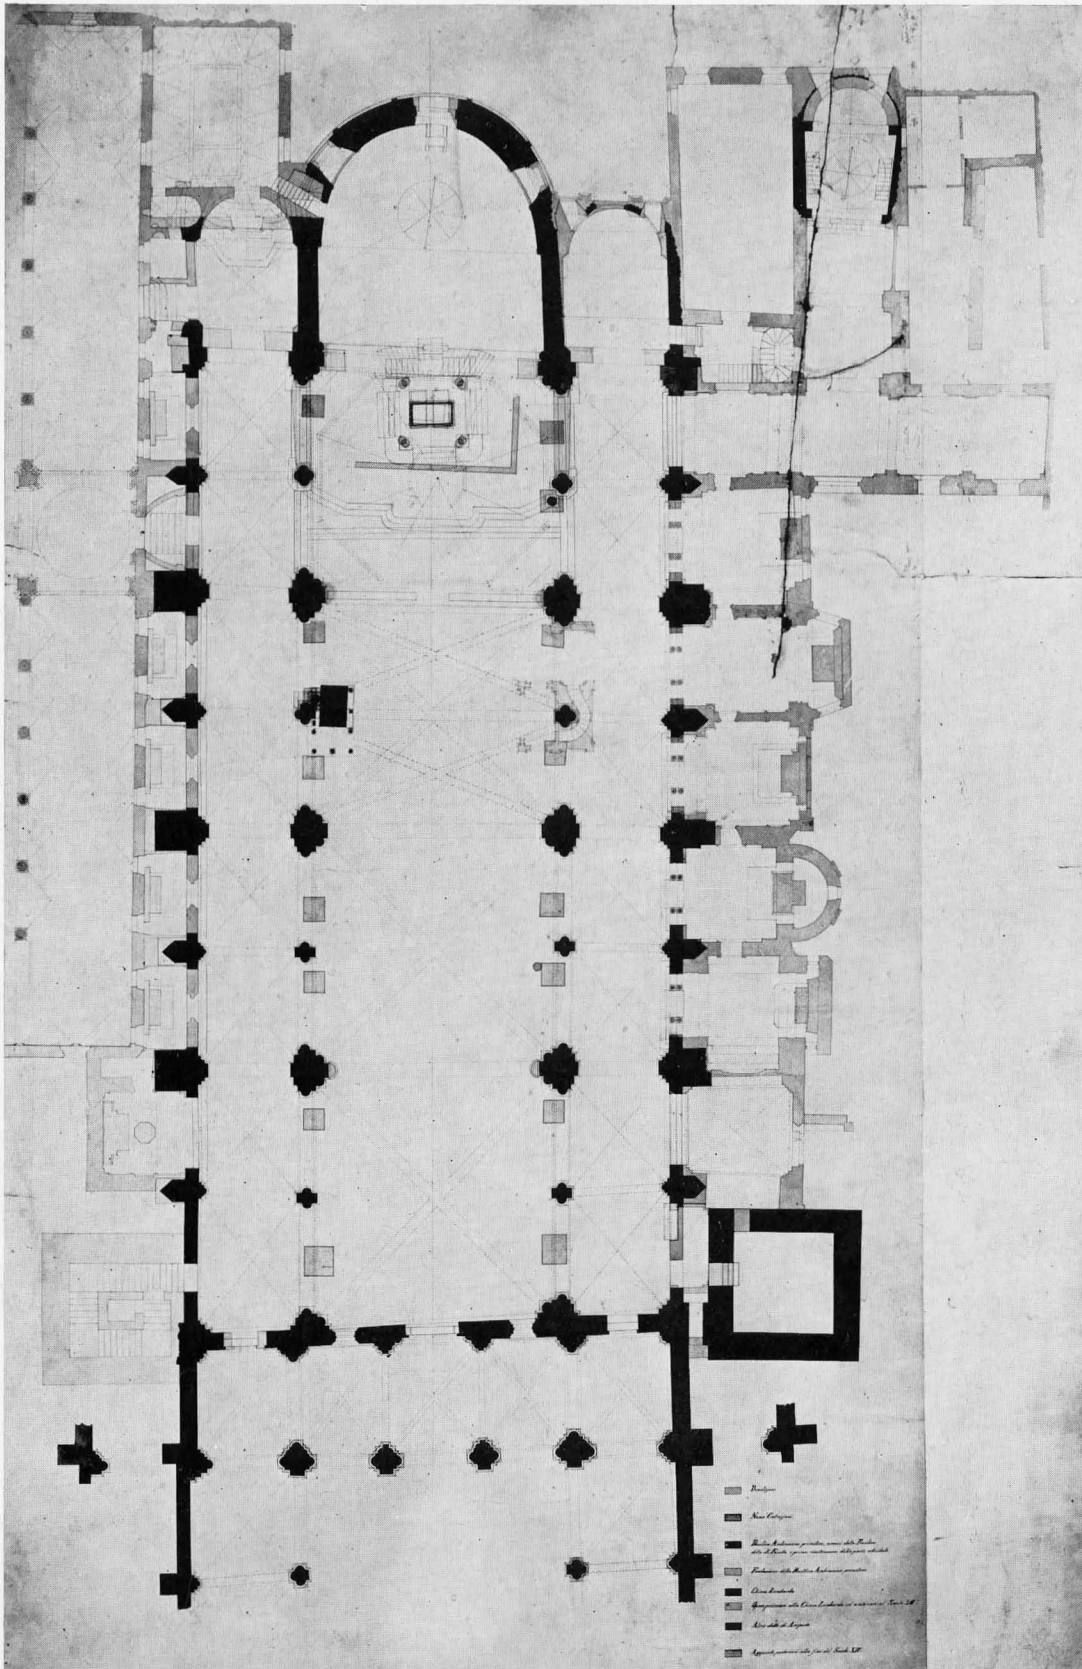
FIGURA I - MILANO, S. AMBROGIO - PIANTA (dal Landriani)
